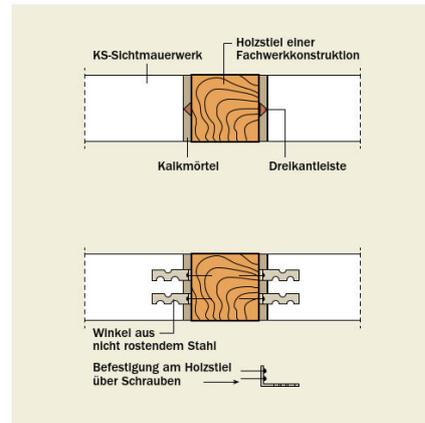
Wandanschluss von KS-Sichtmauerwerk an eine Holzfachwerkkonstruktion
